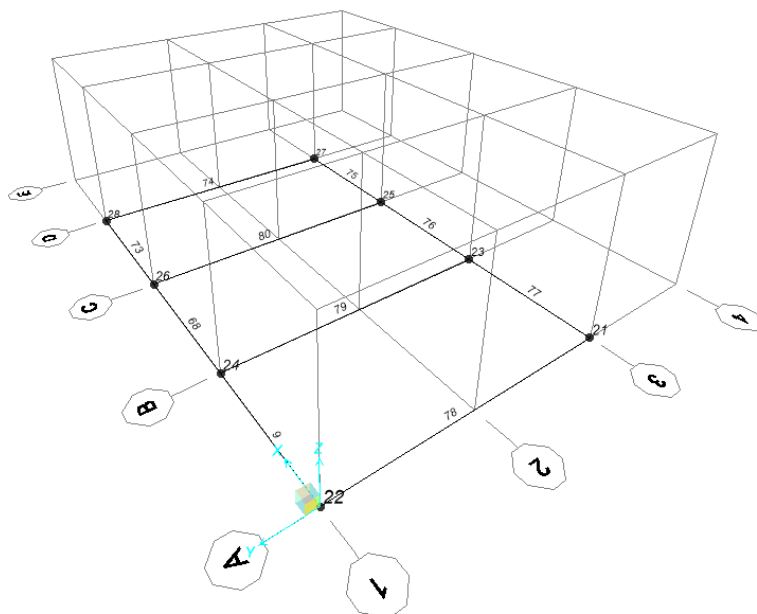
Vista assonometrica modello struttura elevazione/fondazione - numerazione elementi
